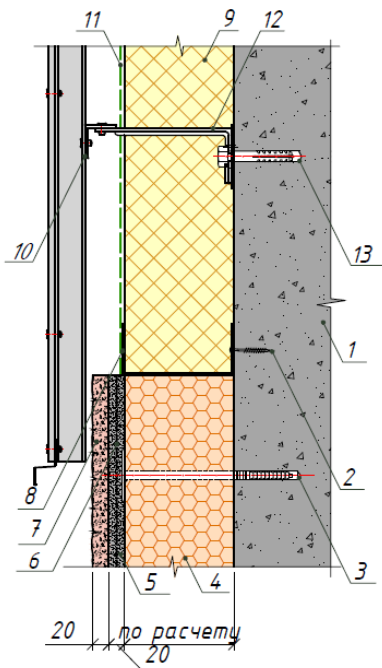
Схема утепления фундаментной плиты (наружной стены подземного этажа)
